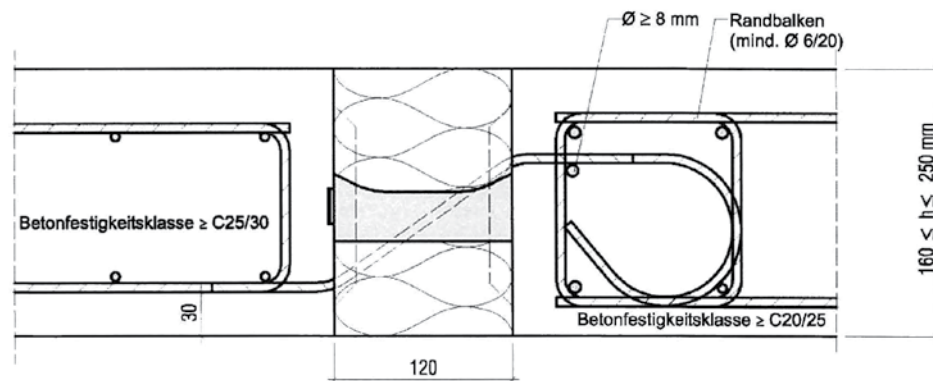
Beispiel Schöck Isokorb Typ Q mit Aufhängebewehrung
